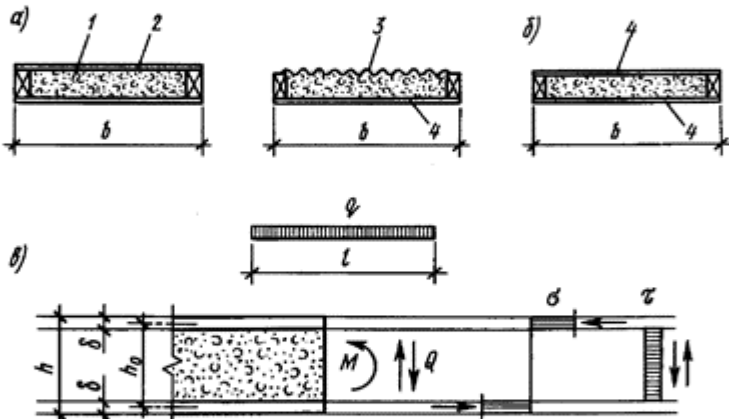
Суцільні тришарові пластмасові плити перерізу:
